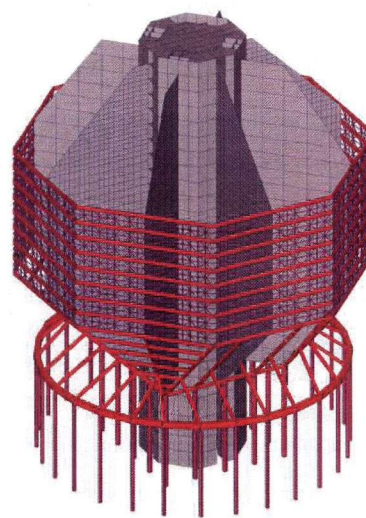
Вариант 6 конструктивной схемы здания книгохранилища (несущими элементами, воспринимающими нагрузку от элементов каркаса, являются восьмигранный железобетонный ствол с 8-ю диафрагмами, раскосная решетка по периметру, опорное кольцо с раскосами и трубобетонные колонны)
